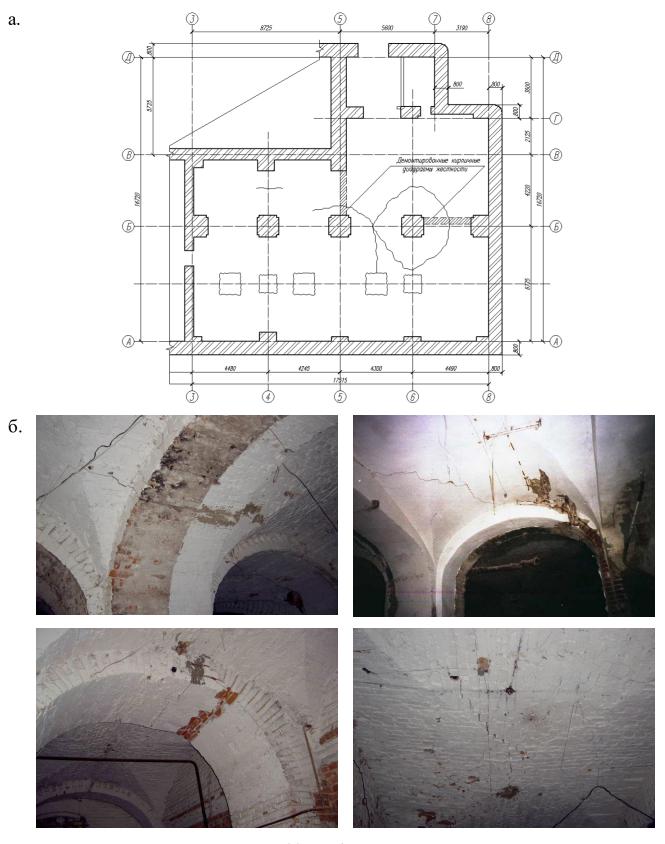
Схемы развития (a) и общий вид трещин в сводах и арках перекрытия подвального помещения (б)
